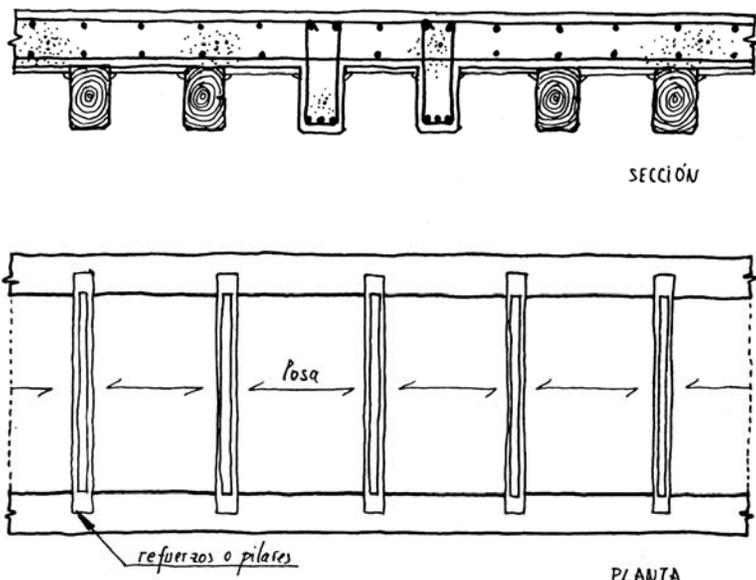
Losa de hormigón armado sobre apoyos reforzados.
